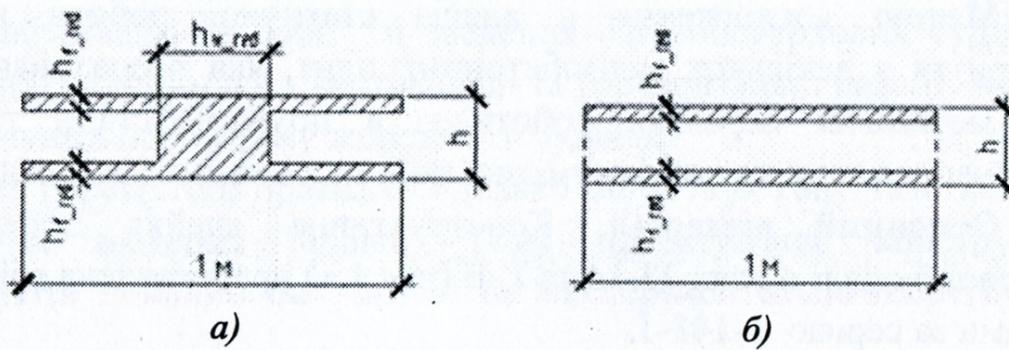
Кінцевоелементна схема ячейки перекриття із багатопорожнинних залізобетонних плит за сер. 1-141-1.: а- КЕ схема диска перекриття; б-КЕ схема ячейки перекриття в осіх 13-14 та Г-Е (перша розрахункова схема); в-КЕ схема диска перекриття; в-КЕ схема ячейки перекриття , де одна з плит виключена із роботи.
